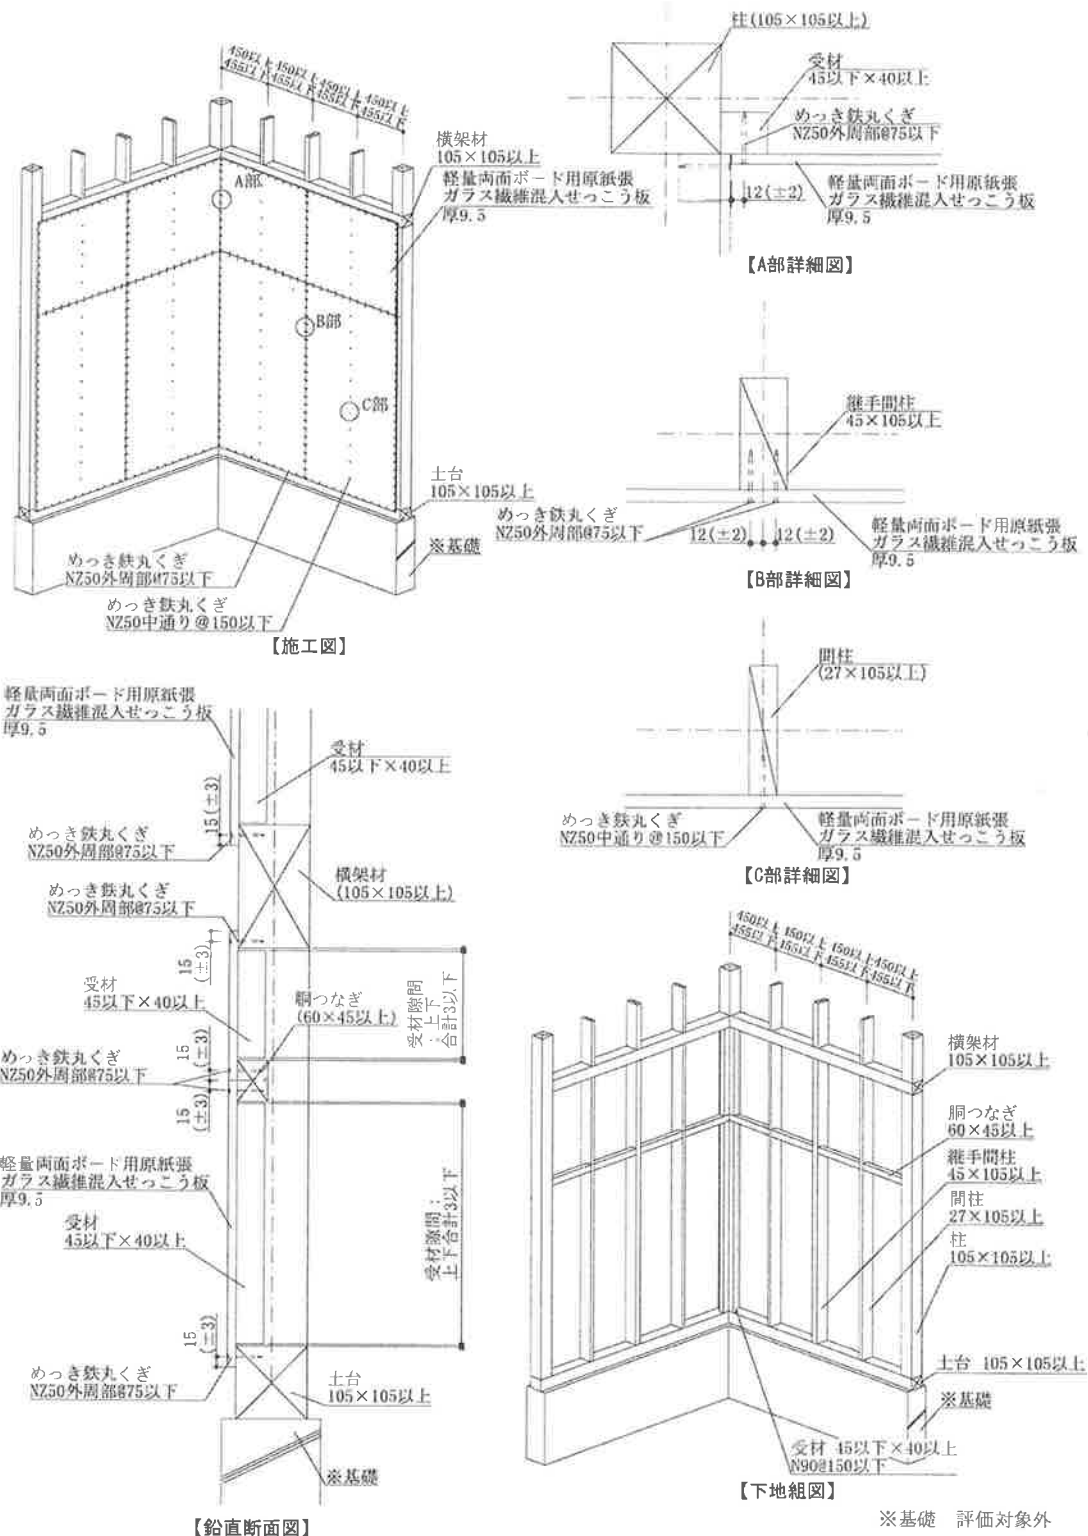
施工詳細図：縦継ぎ張りの場合 (寸法単位：mm)
